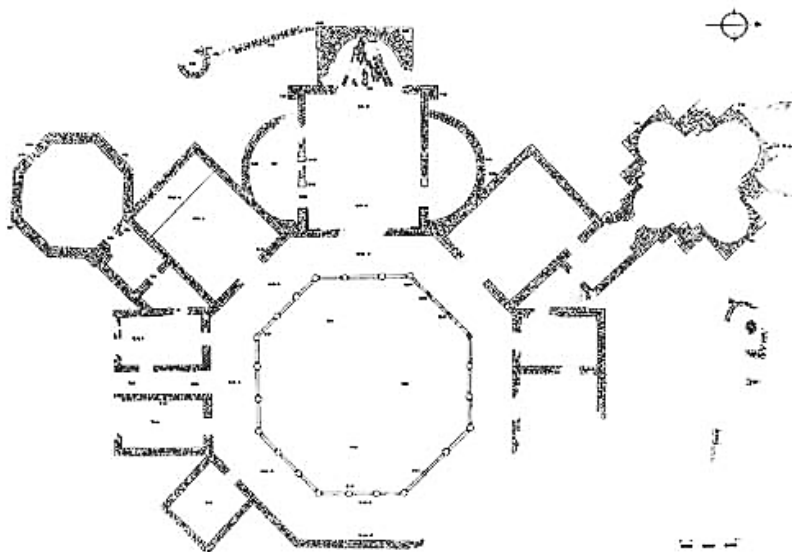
Planimetría de la *villa* de Rabaçal (Penela, Coimbra, Portugal).
